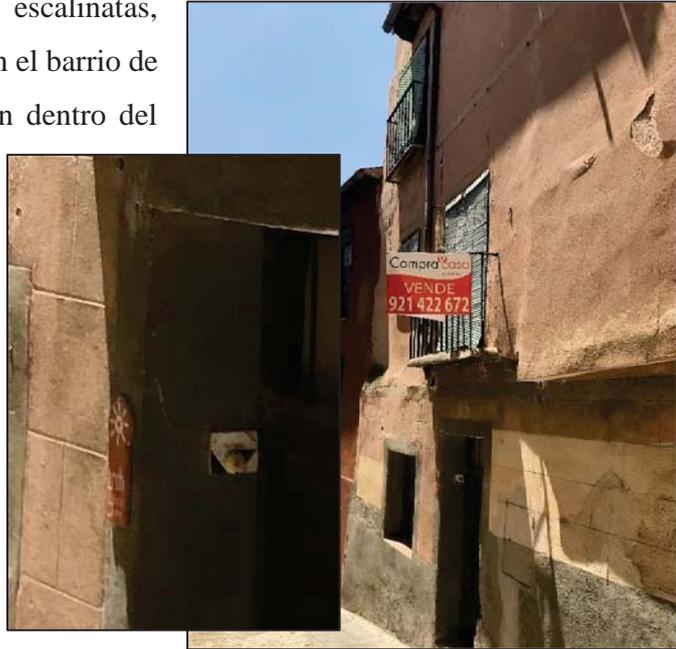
Inmueble Santa Ana, 6. En muy mal estado y con la placa del ARCH (sólo se modificó el cableado).
